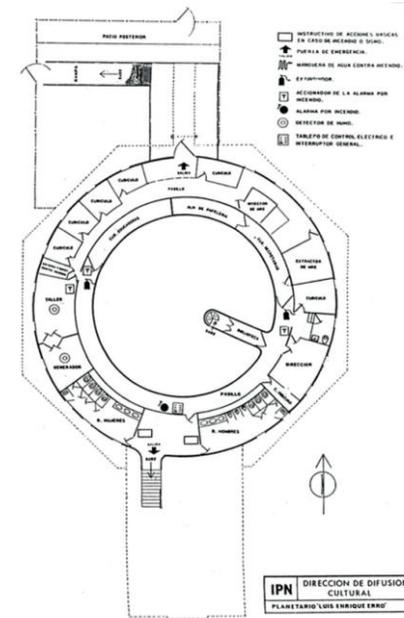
Planta arquitectónica planetario Enrique Erro
